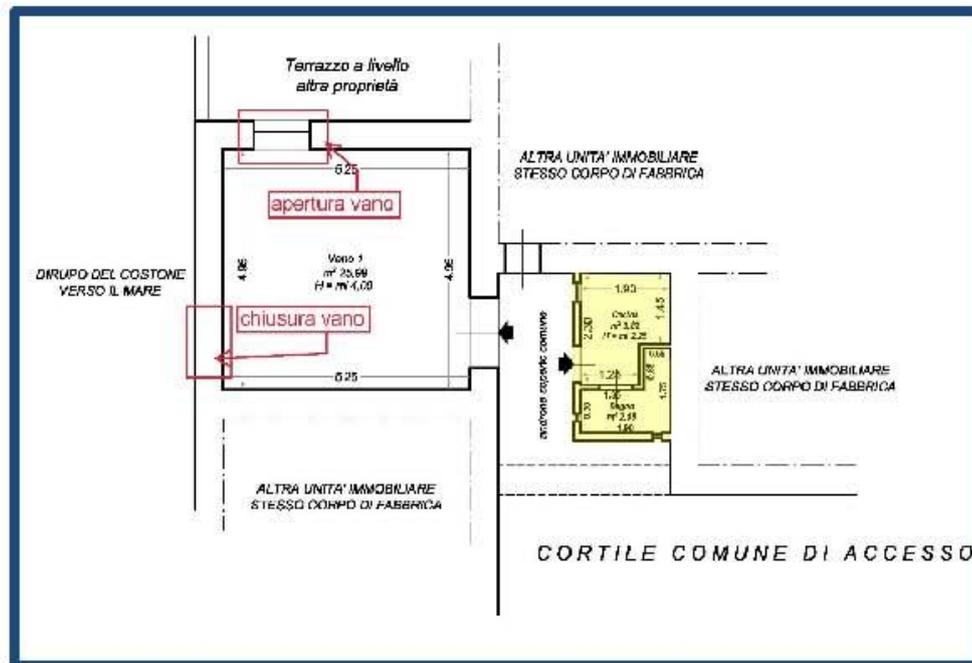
Stralcio Planimetria dell'attuale stato dei luoghi.
